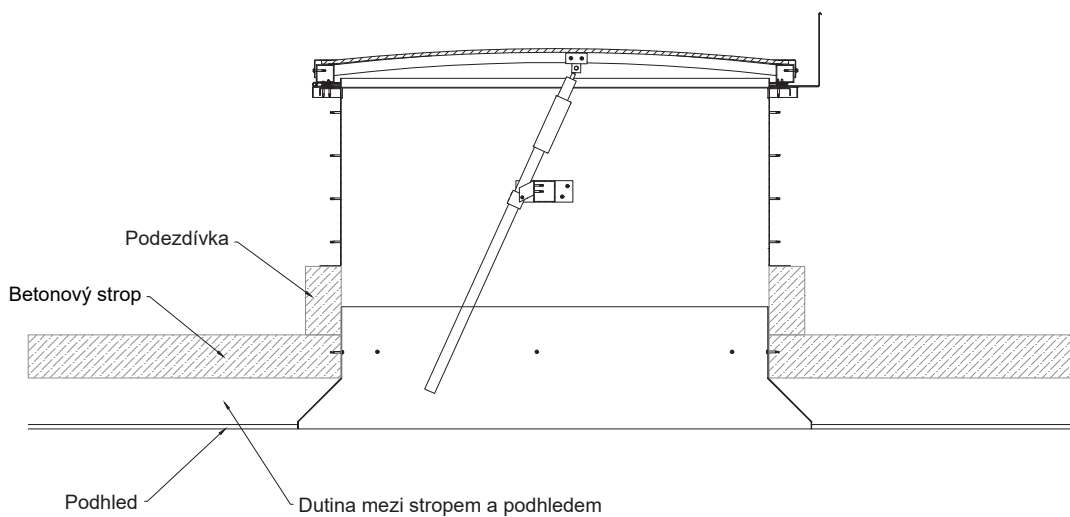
Průřez klapky s tepelnou izolací pro montáž na betonovou stranu s výškou/podstavcem.
